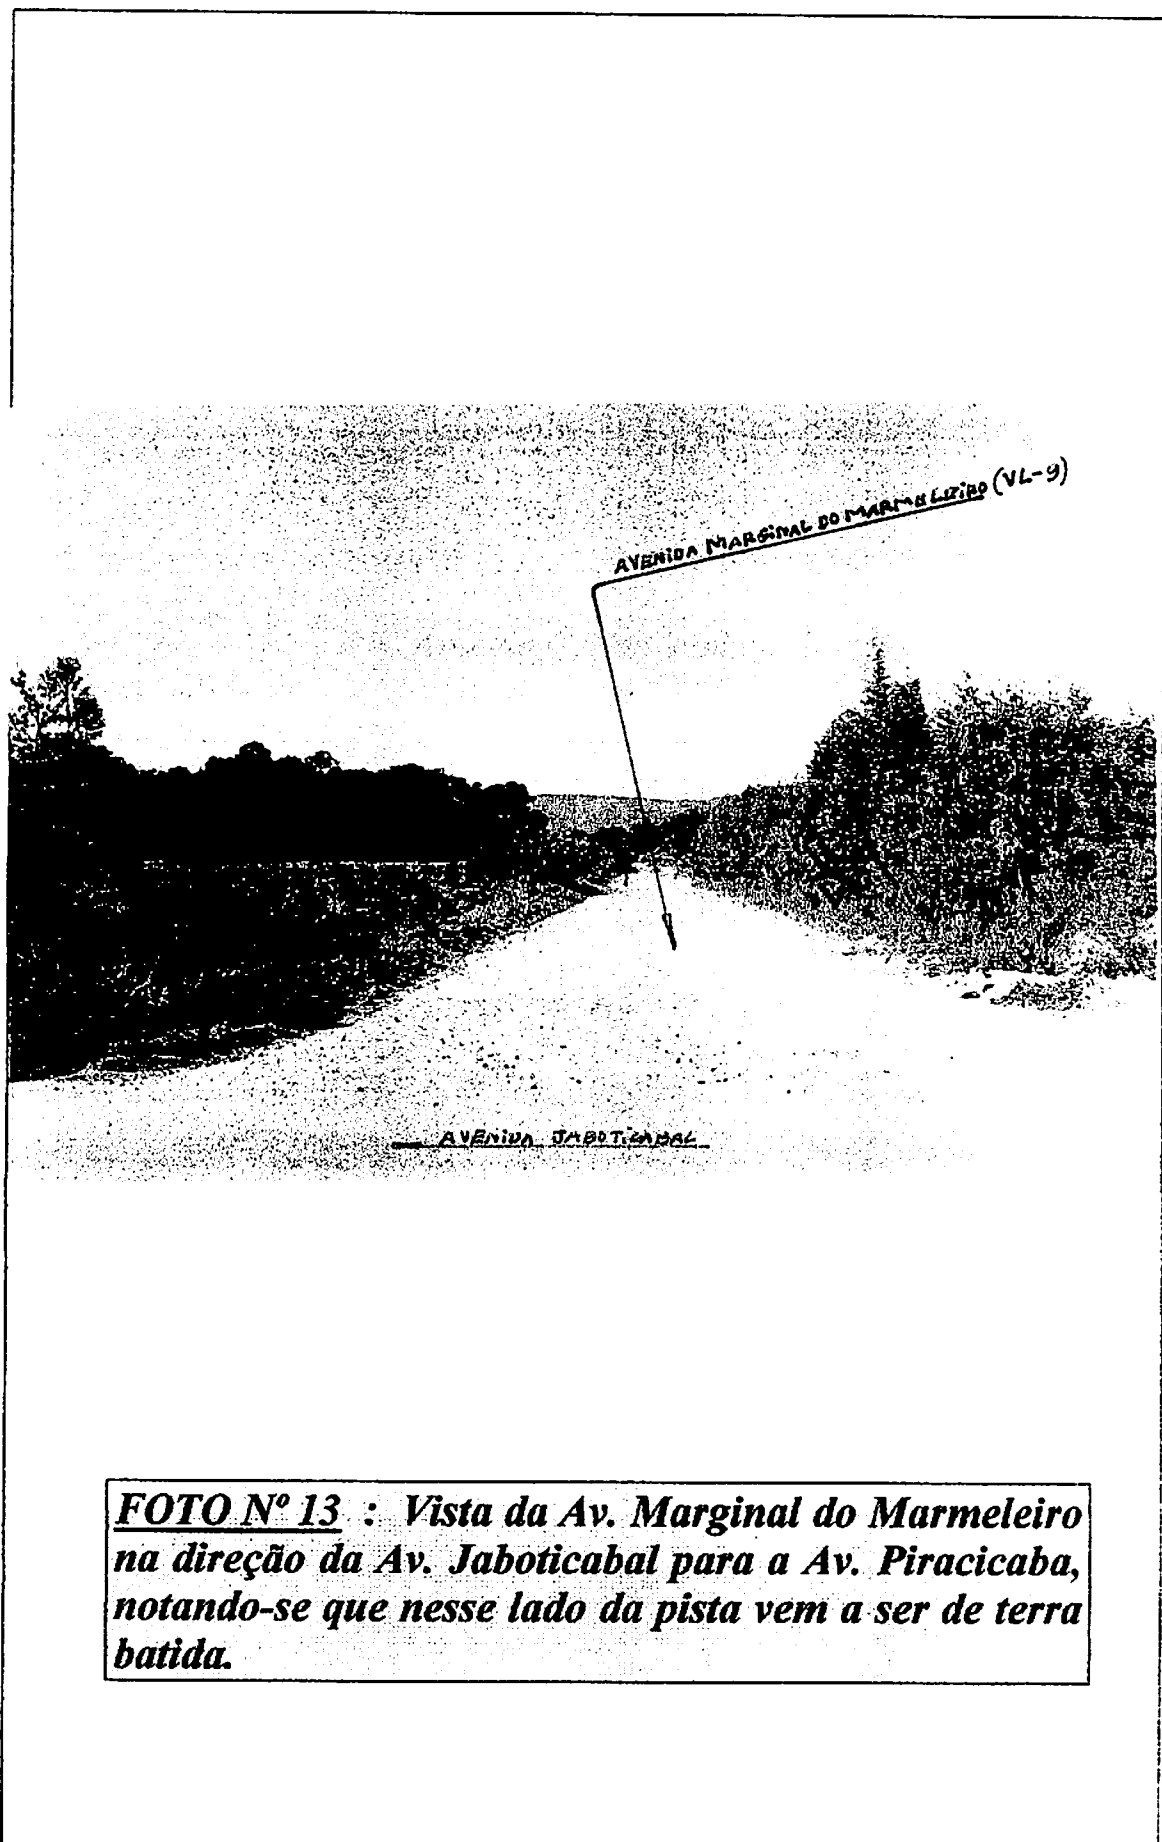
Vista da Av. Marginal do Marmeleiro na direção da Av. Jaboticabal para a Av. Piracicaba, notando-se que nesse lado da pista vem a ser de terra batida.
